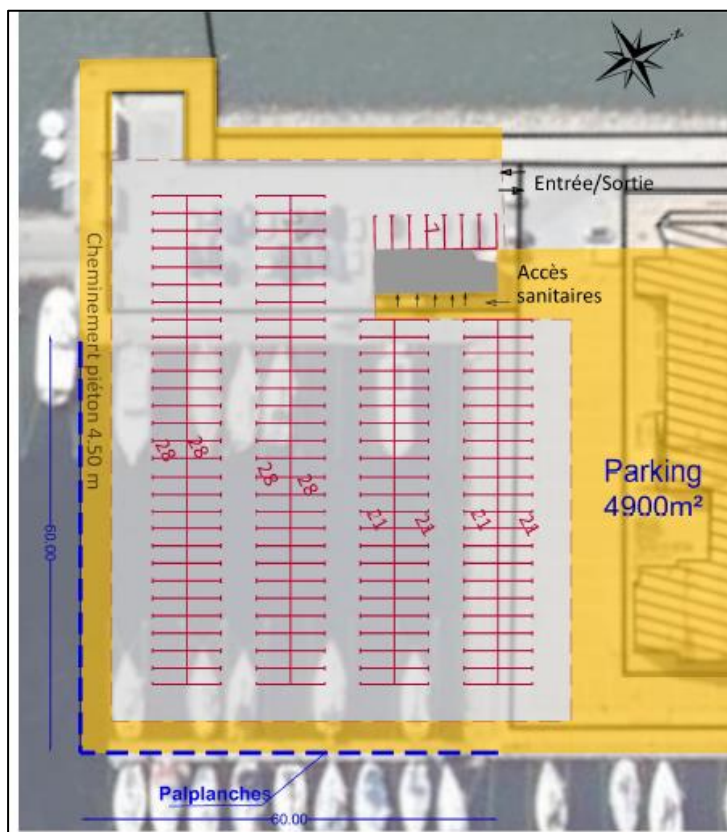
Plan du parking de 203 places projeté (remblai dans le bassin A)
